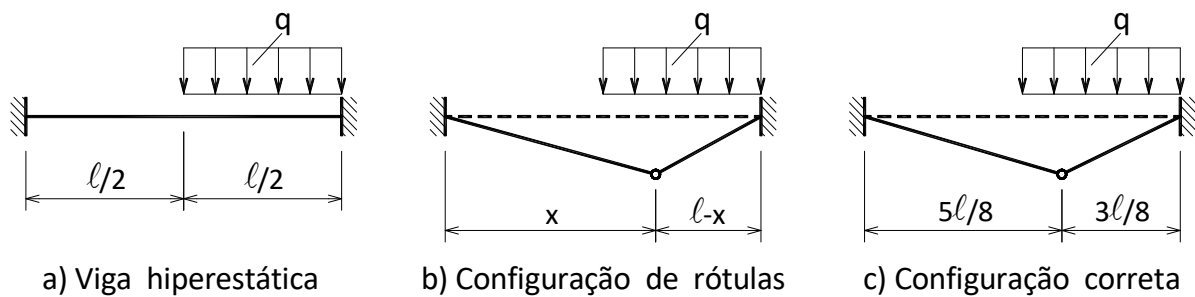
Viga hiperestática e configurações de rótulas
